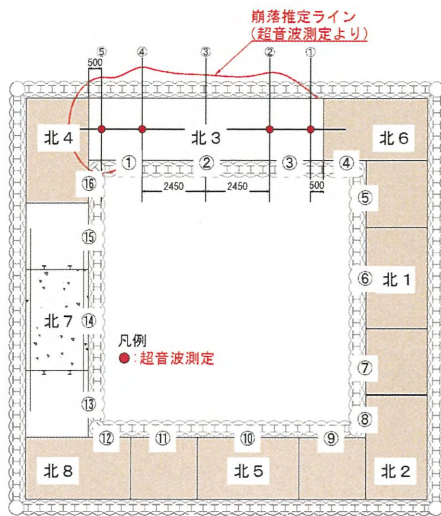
コンクリート未充填箇所断面図 (SMW直下 T.P. -13.0 m 付近)
